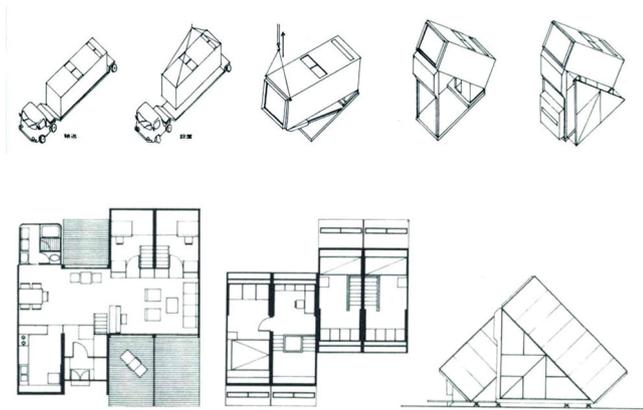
Montaje, plantas y alzados Tilted Box, Kurokawa, 1965
